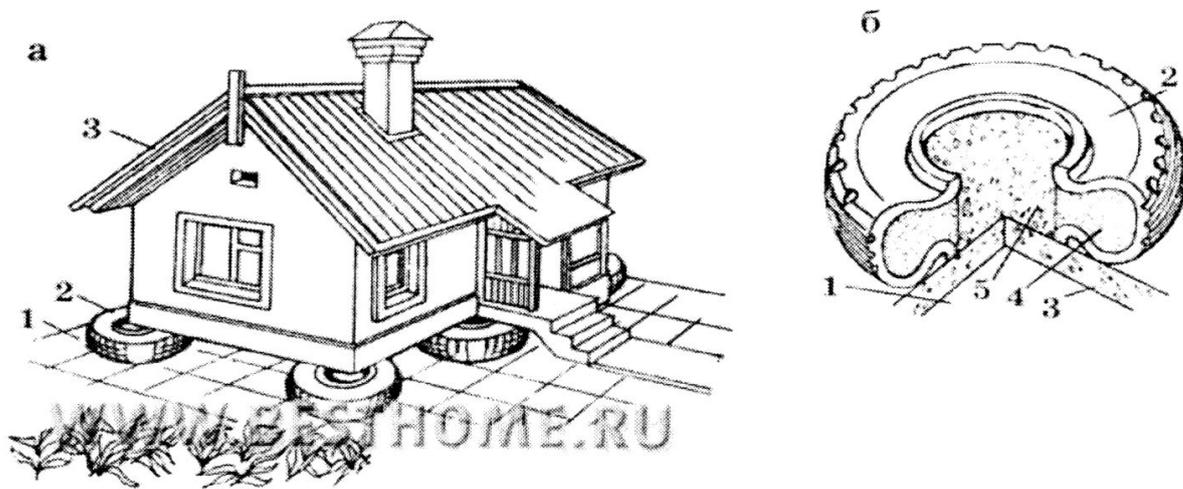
Фундамент из автопокрышек: а - общий вид дома: 1 - плита основания; 2 - автопокрышка; 3 - жилой дом; б - конструкция фундамента: 1 – утрамбованный грунт основания; 2 - автопокрышка; 3 - бетонная плита основания; 4 - песок; 5 – гравий.
